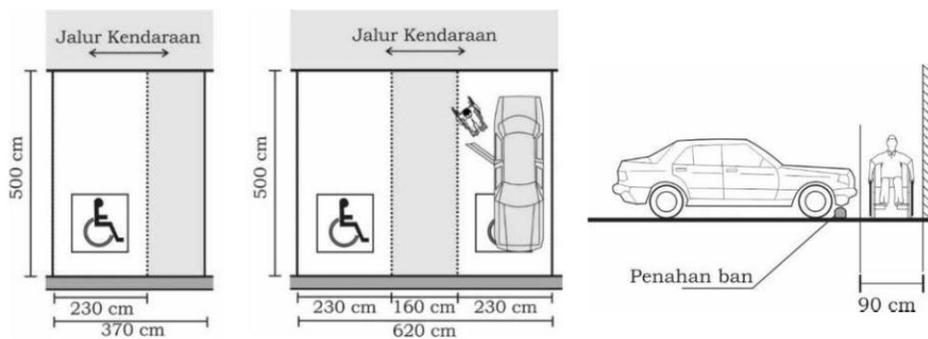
Dimensi ruang parkir dengan sudut 90°
